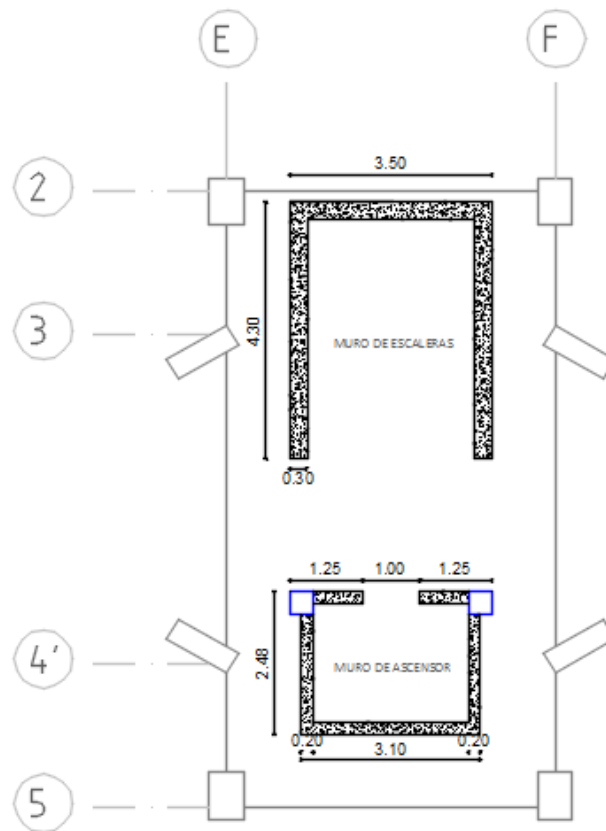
Vista en planta de ubicación de muros existentes en el Edificio Silva Núñez
